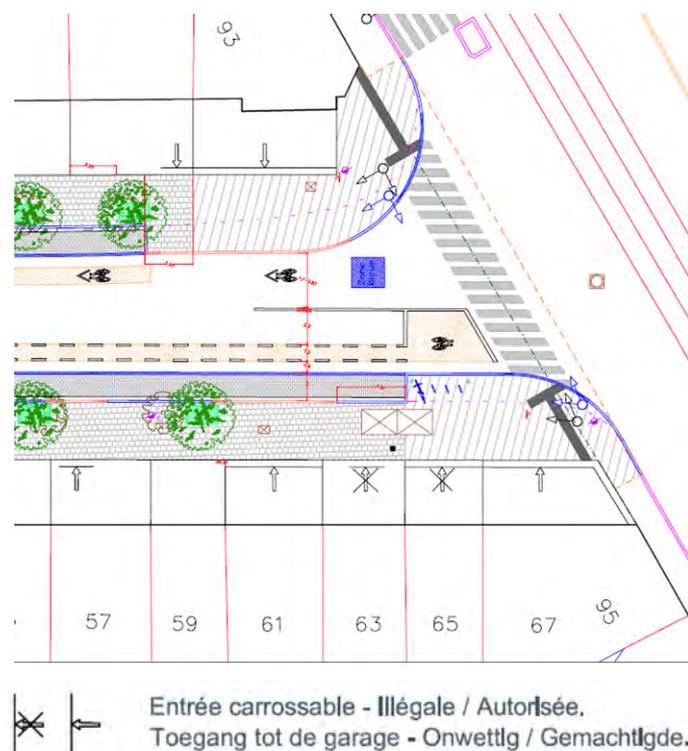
Extrait du plan – Réaménagement de l'avenue Demolder au coin avec le boulevard Lambermont (Commune de Schaerbeek, 2018)
